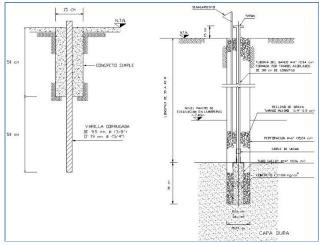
Detalle constructivo de las referencias superficiales R.S. (izquierda) y del banco de nivel profundo B.N.P. (derecha).
